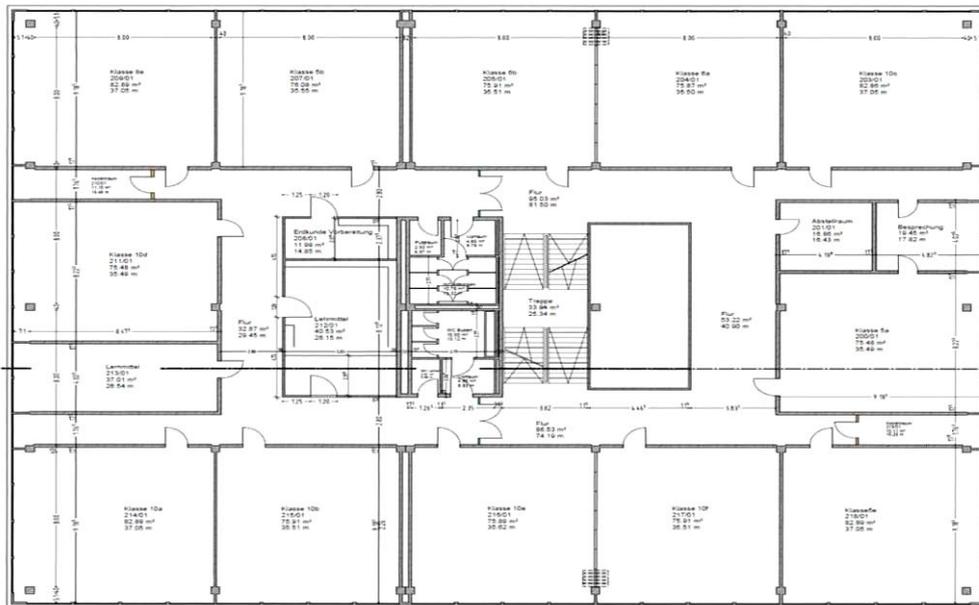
Grundriss des 1. Obergeschosses der Theodor-Heuss-Realschule.
